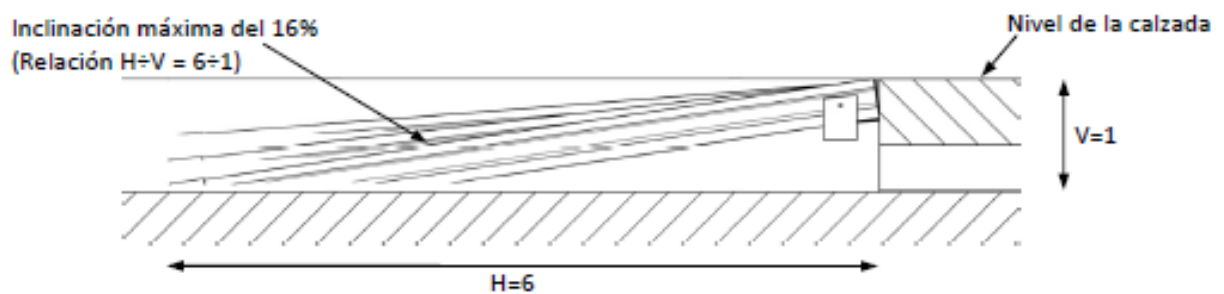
Vista en sección de un sistema de protección de pasos salvacunetas
